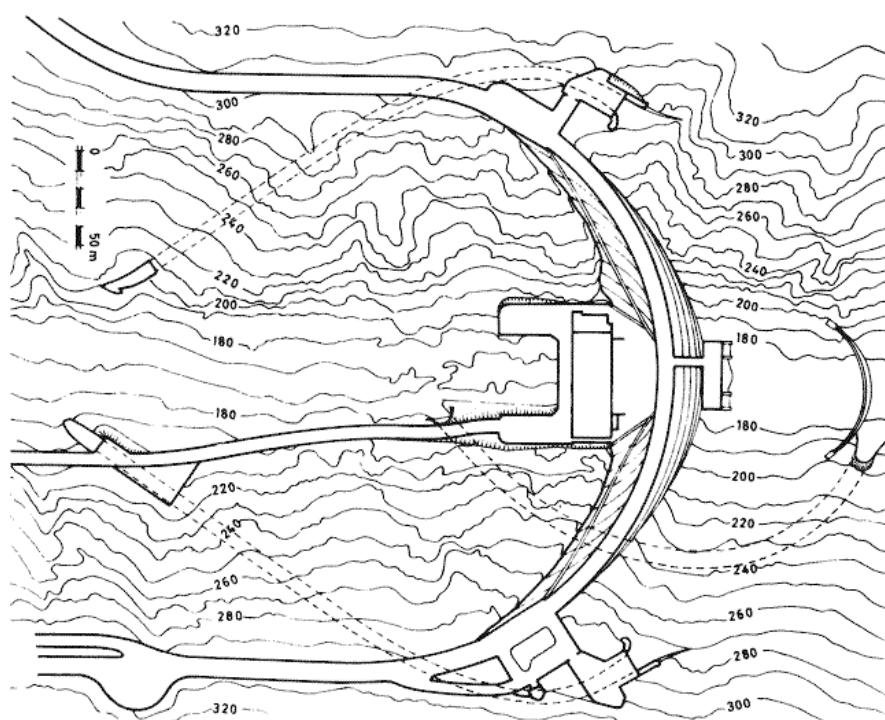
Barragem do Cabril. Planta (fonte: www.inag.pt)
